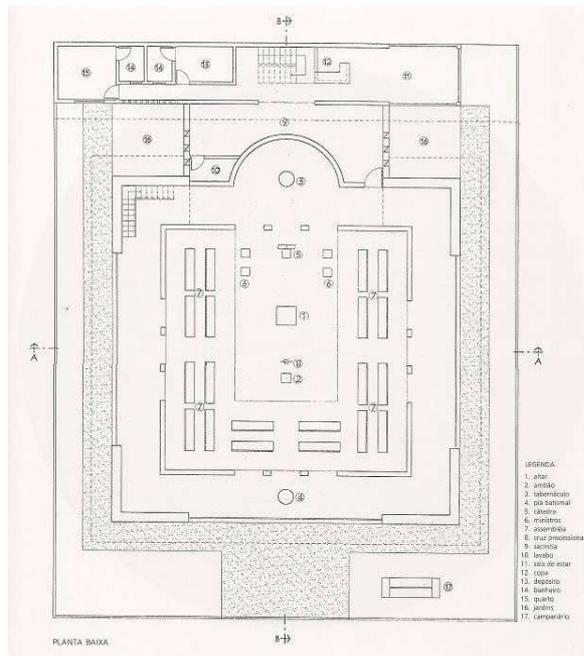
Planta Baixa Santuário da Vida – São Paulo
